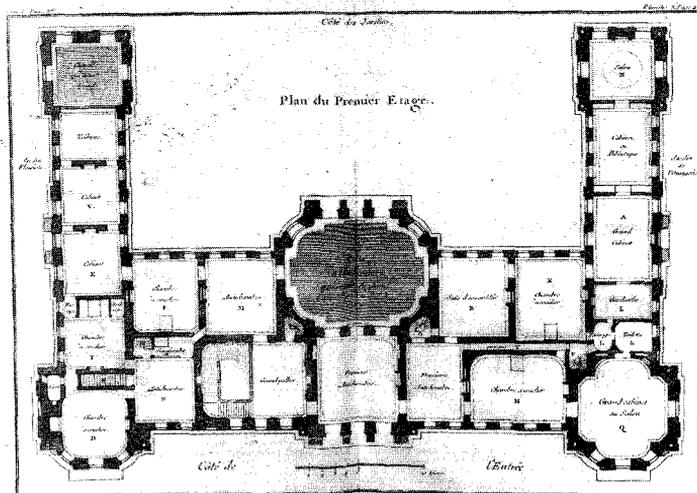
J. F. Blondel, Proyecto para un Palacio. Planta principal (1737).
